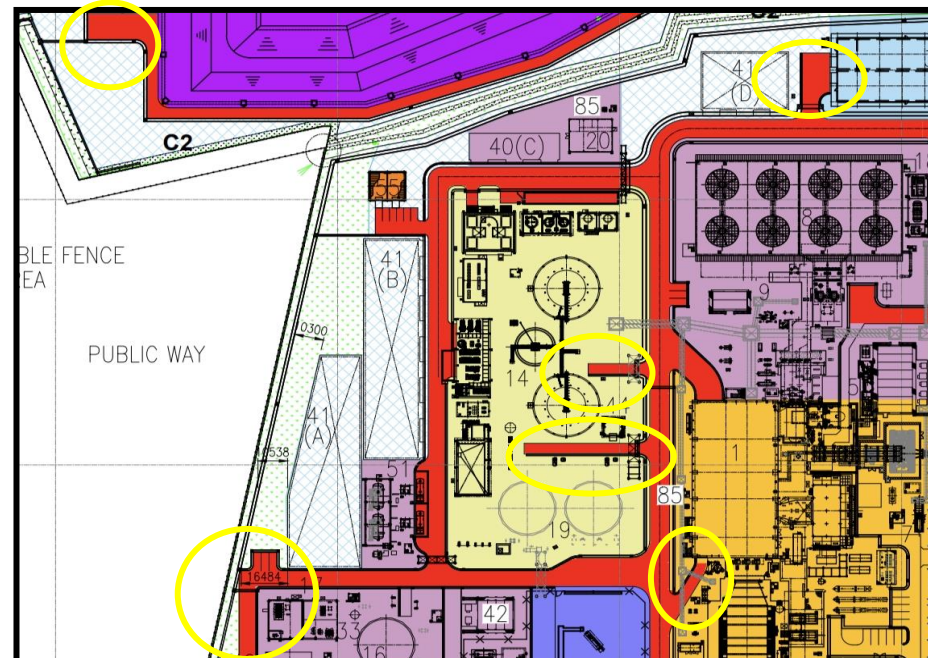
ตำแหน่งการเพิ่มเติมอาคาร Waste Storage Building และพื้นที่ Laydown Area For Maintenance ในผังการใช้ประโยชน์โครงการ
